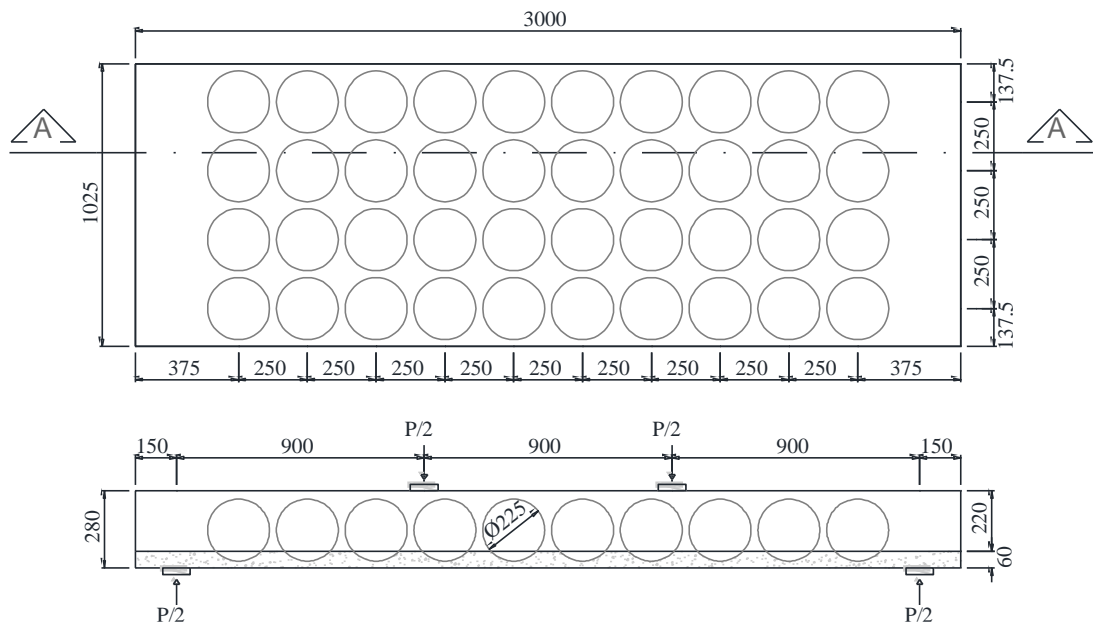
Laje *BubbleDeck* BD28-F1 (dimensões em mm)
